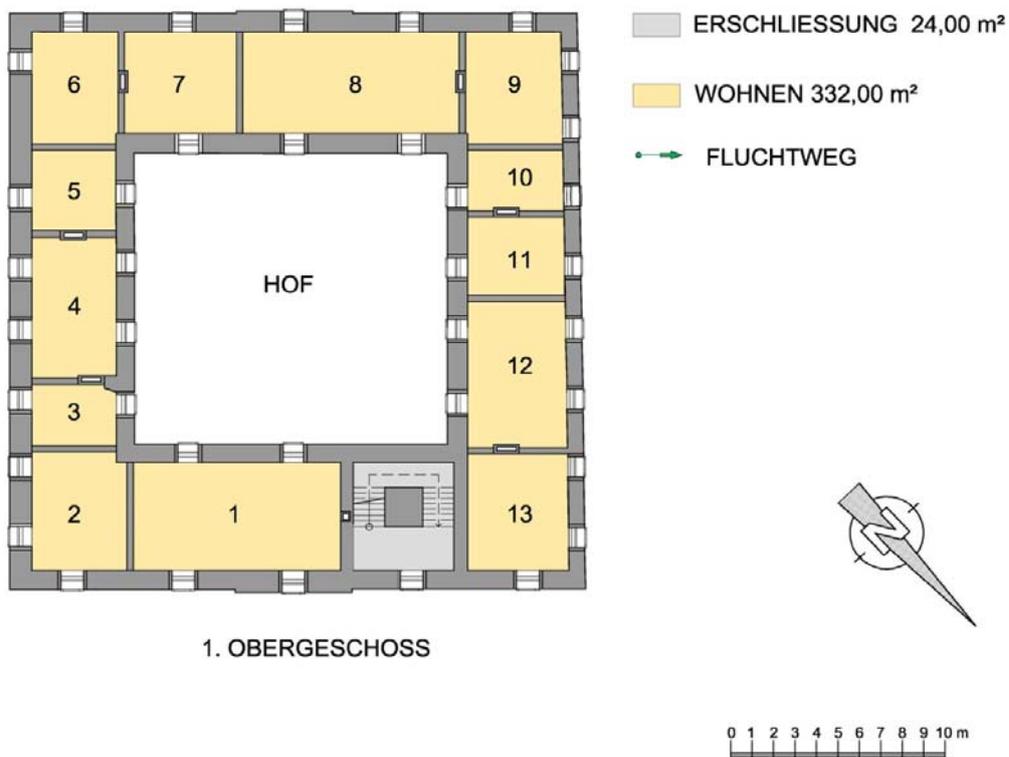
zeigt den Grundriss des Schlosses Raggendorf
